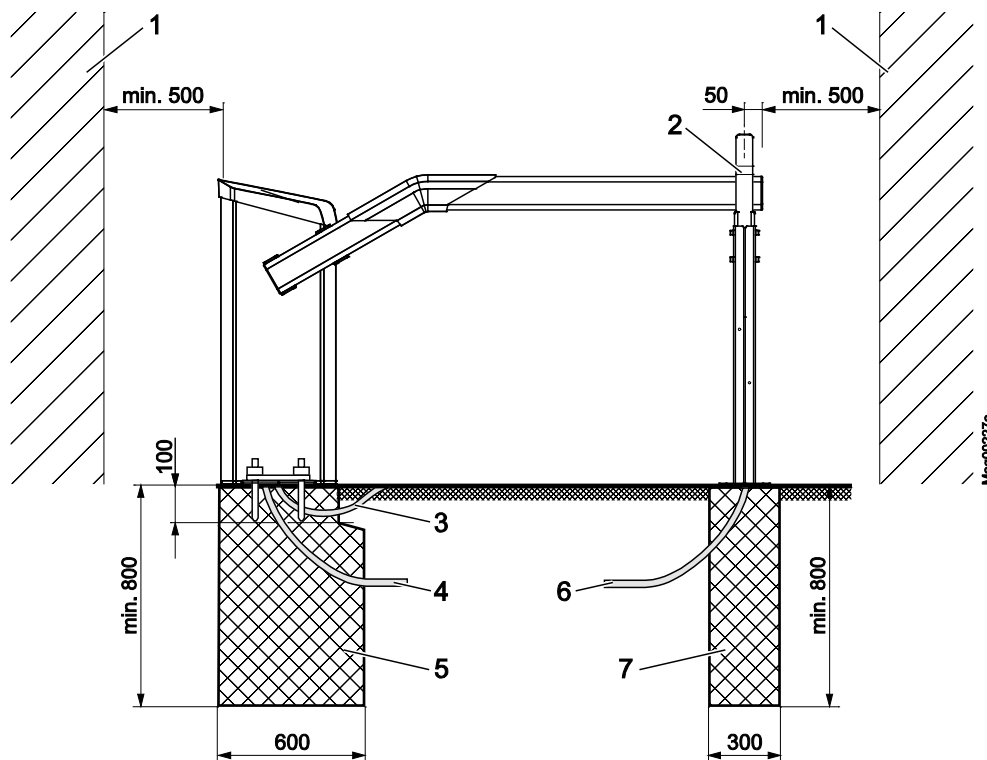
Montage Schrankenanlage, hier dargestellt für Schrankentyp "Access/Parking" (Maße in mm)
